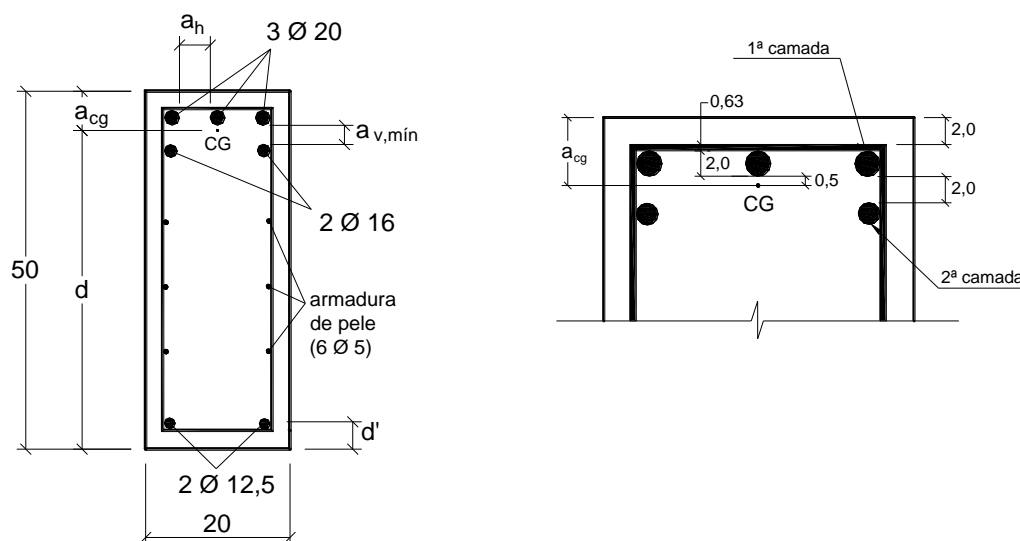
Detalhamento das armaduras longitudinais de flexão na seção transversal.
